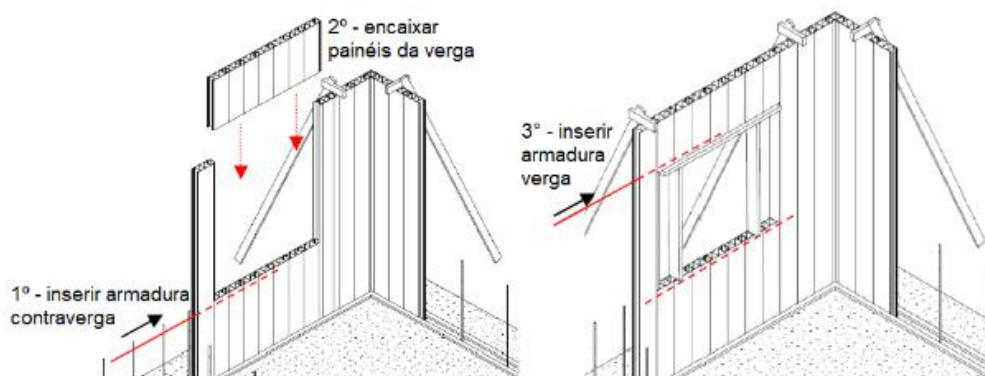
Ilustração das etapas para posicionamento das armaduras horizontais nas regiões de verga e contraverga: 1º - inserção da barra de armadura horizontal já cortada no comprimento adequado na região da contraverga; 2º - encaixe dos painéis de PVC rígido na região da verga; 3º - inserção da barra de armadura horizontal já cortada no comprimento adequado na região da verga. (Sem escala).
